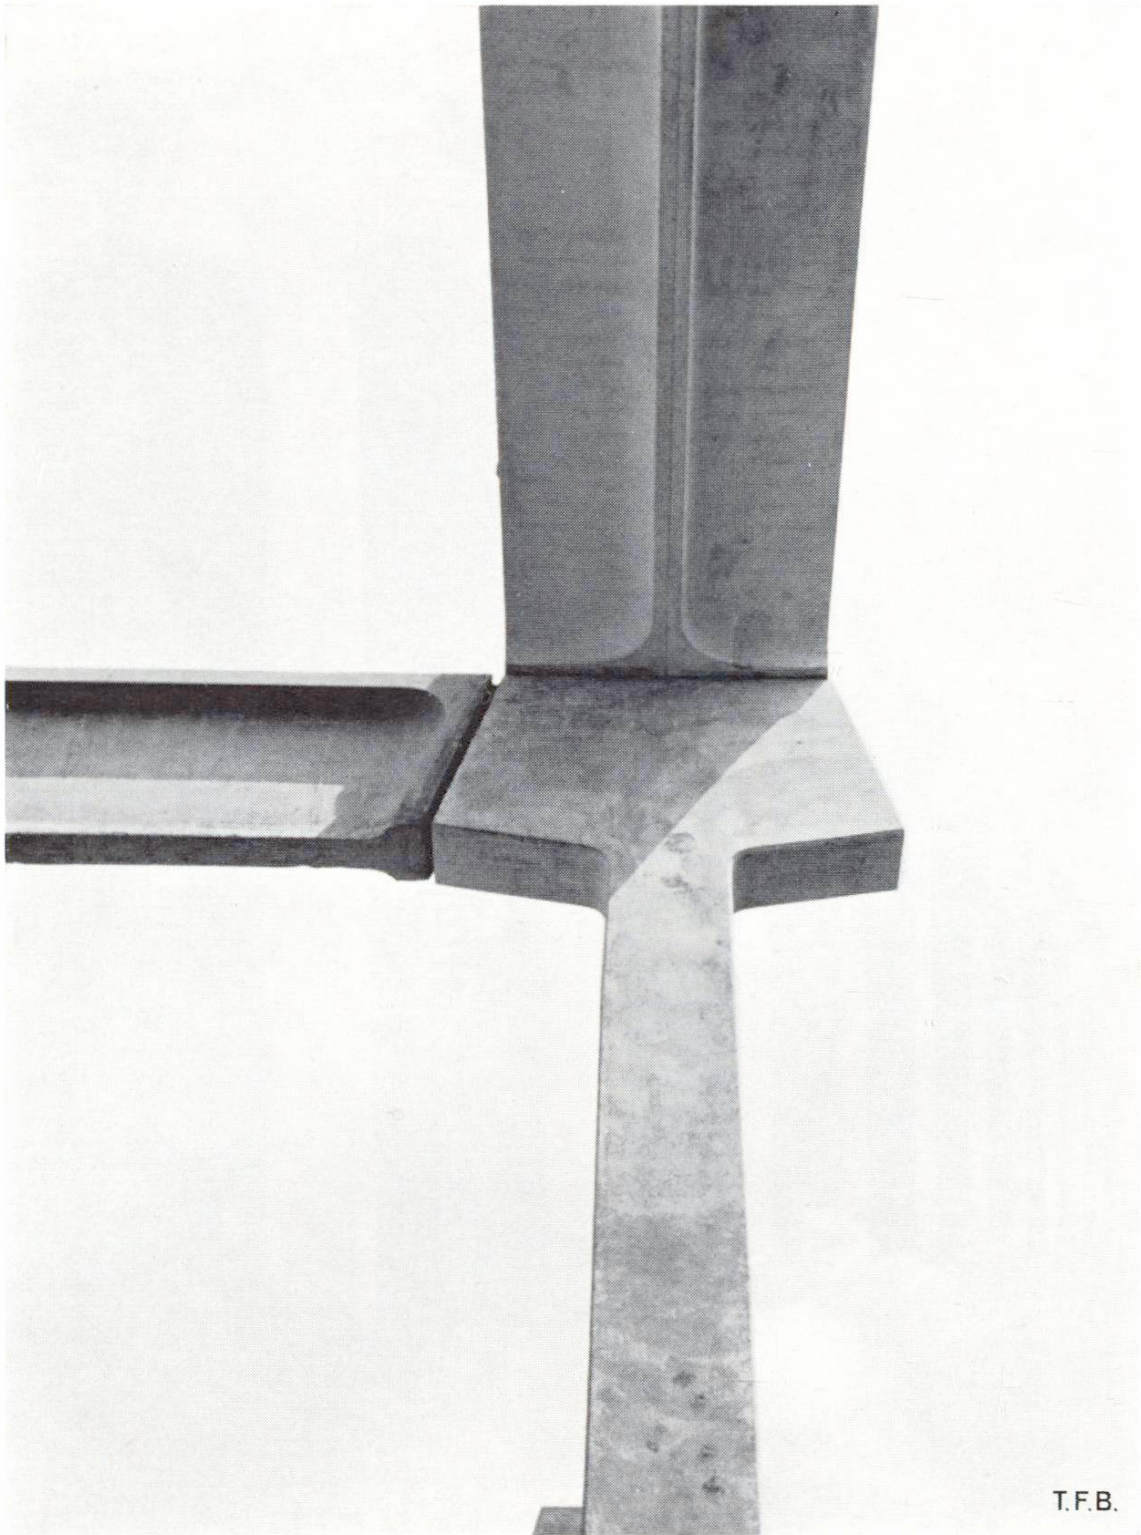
Die drei Elemente entsprechen den drei rechtwinklig zueinander stehenden Raumkoordinaten.
